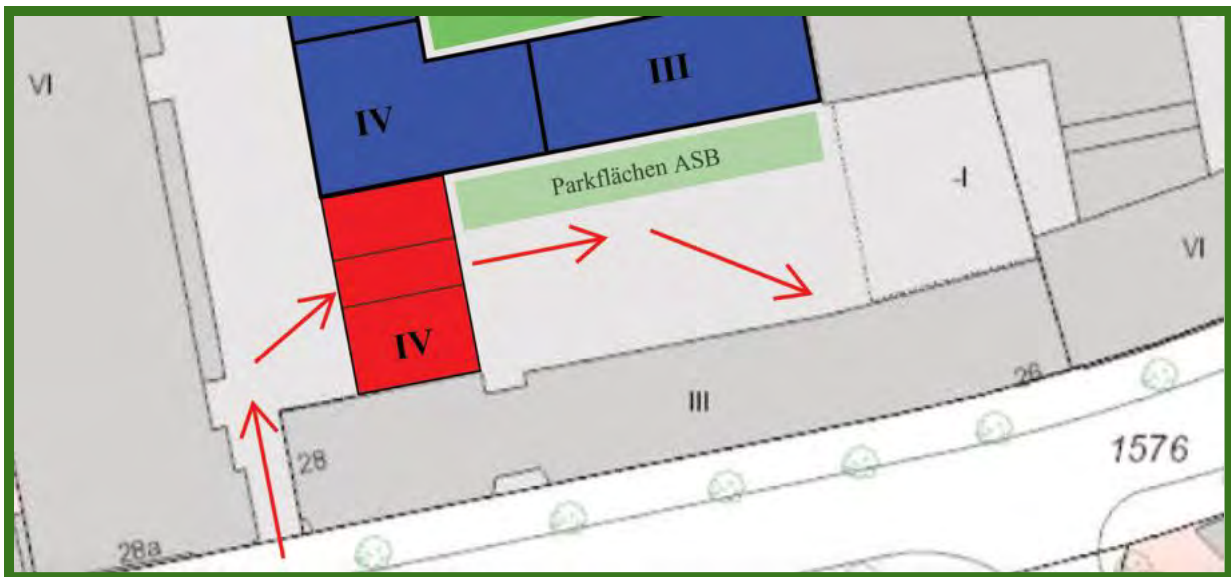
LKW-Zufahrt Sanitätshaus MPM an der Behringstraße 26 / Parkflächen ASB
